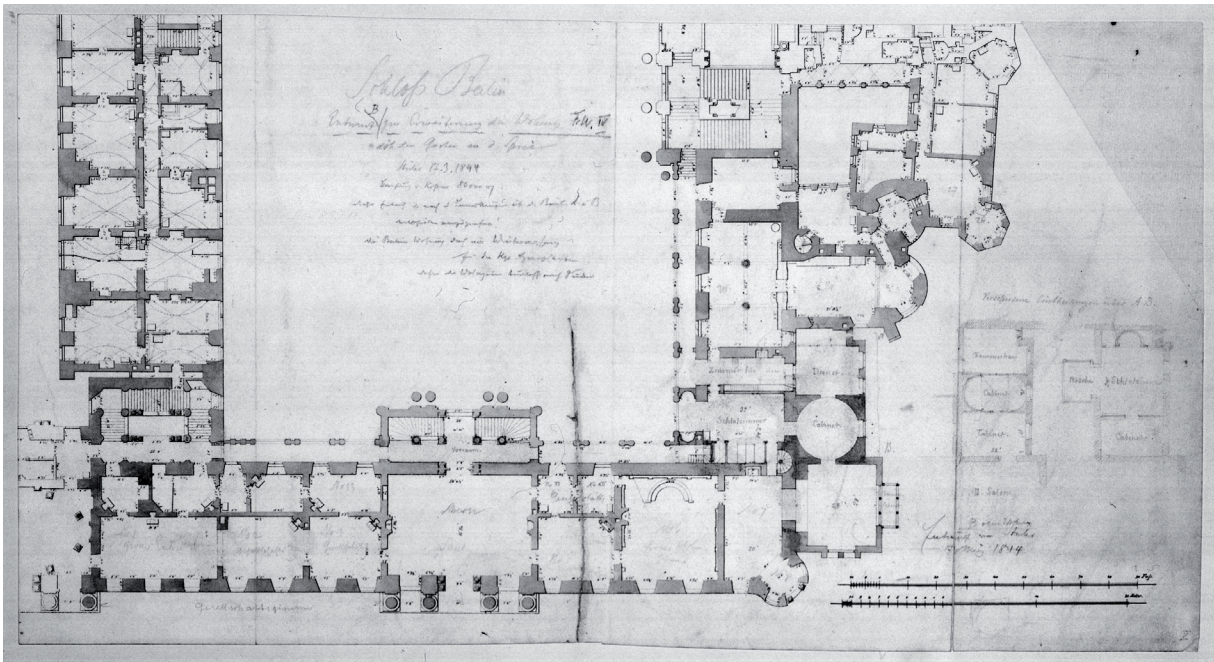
Friedrich August Stüler: Grundrissentwurf für die Erweiterung der Wohnung Friedrich Wilhelms IV. im Berliner Schloss (Erstes Stockwerk), Plan B, 1844, Feder in Schwarz (SPSG, Plslg. Mappe 135, BA 3275) (Foto: SPSG, DIZ/Fotothek)
